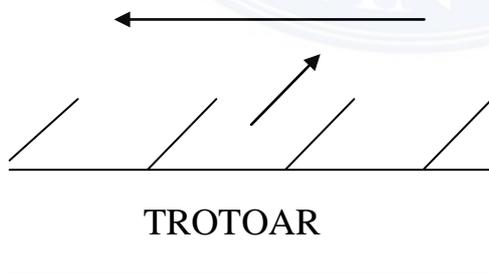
Tapak lintasan kendaraan yang memasuki ruang parkir
